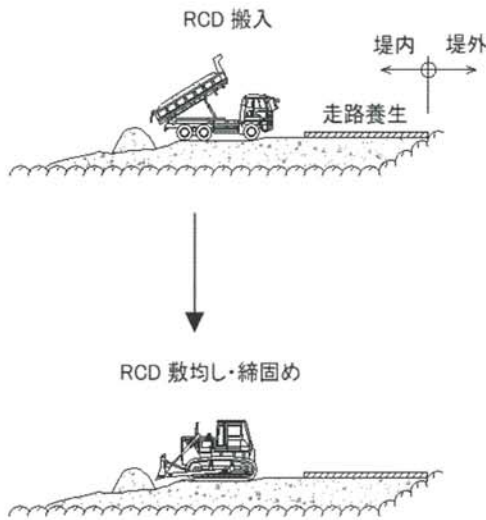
河床着岩部RCD工法の施工概要説明⁶⁾
